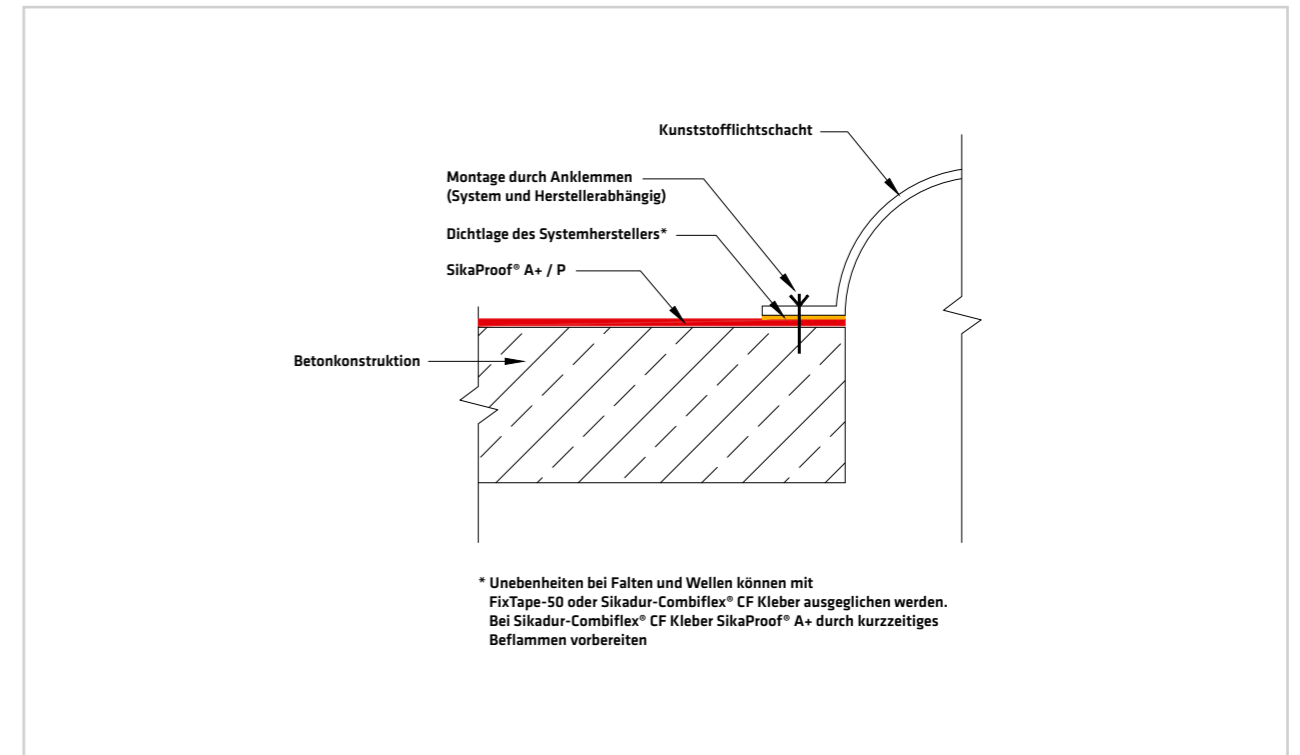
Anschluss an Bestand mit Klemmkonstruktion
